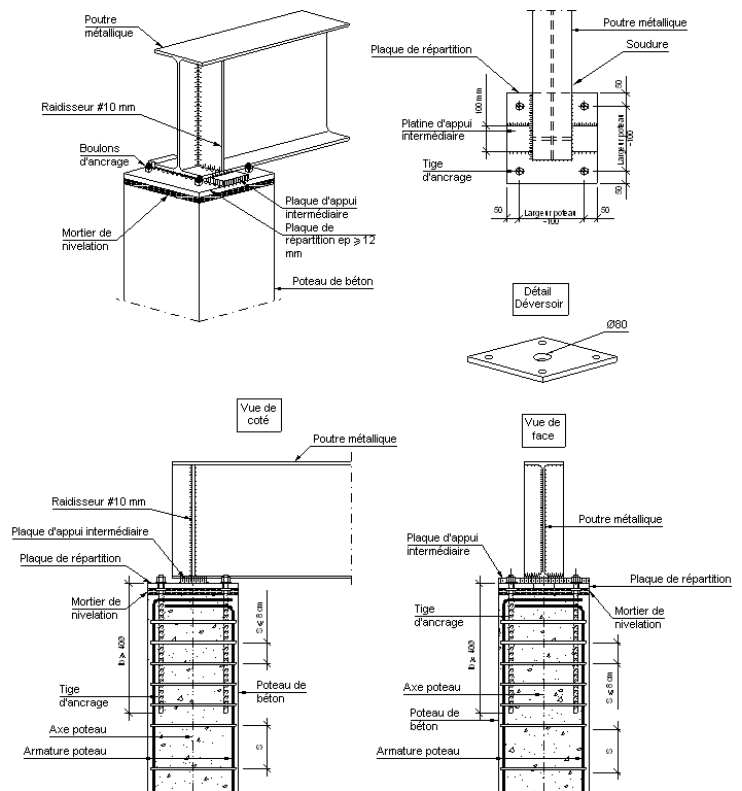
la jonction entre un poteau en béton et une poutre métallique
